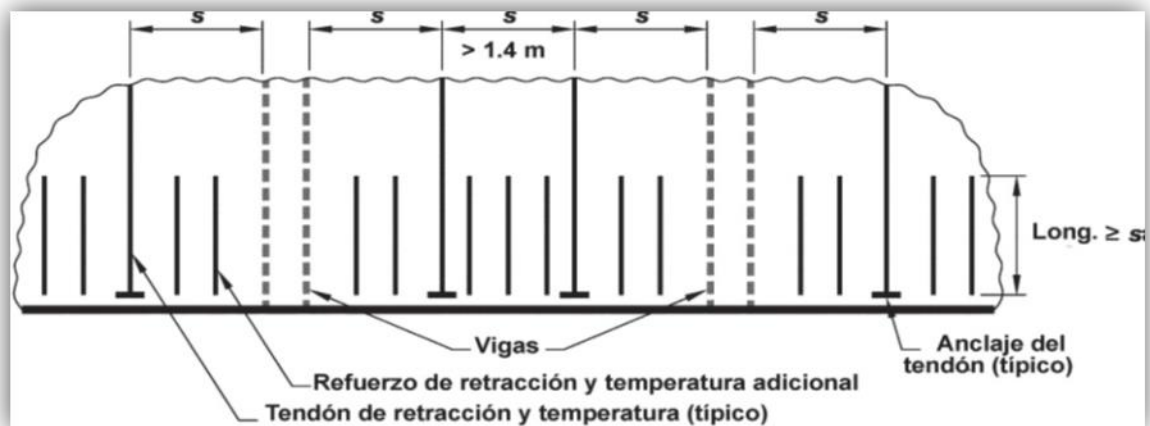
Vista en planta del borde de la losa mostrando el refuerzo adicional de retracción y temperatura (318, 2019).
